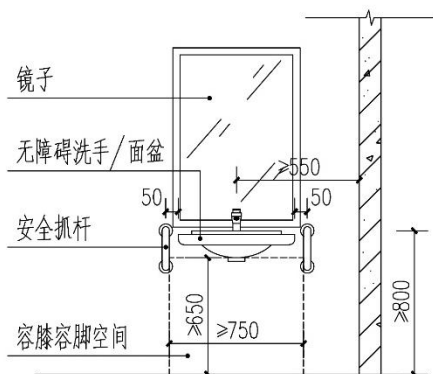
立式无障碍洗手盆正立面示意图
